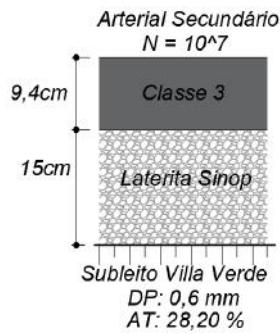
Estruturas de pavimentos propostas para o solo Villa Verde e Laterita Sinop
